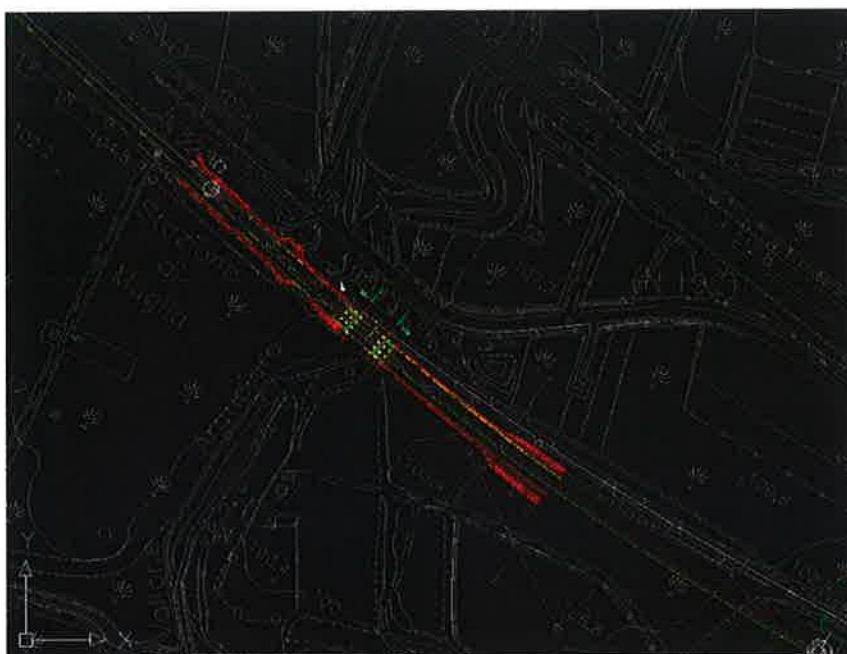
Stralcio planimetrico del nuovo tracciato ferroviario - Vallone Aranciario
